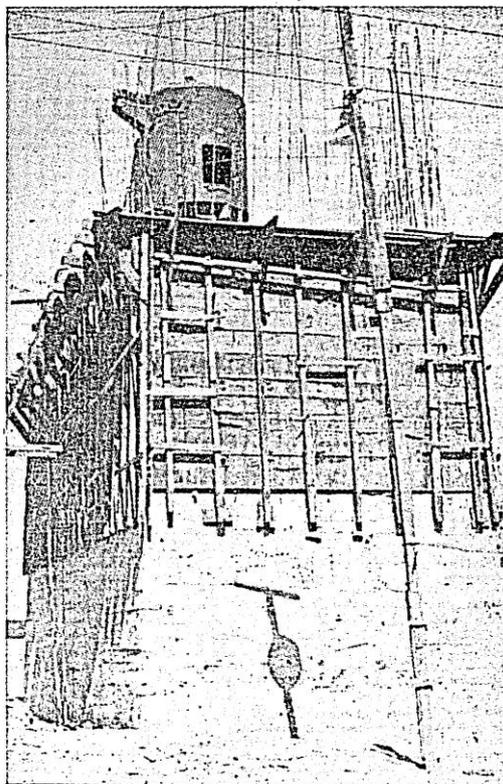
Construção dos pilares da ponte sobre o Rio Grande.
